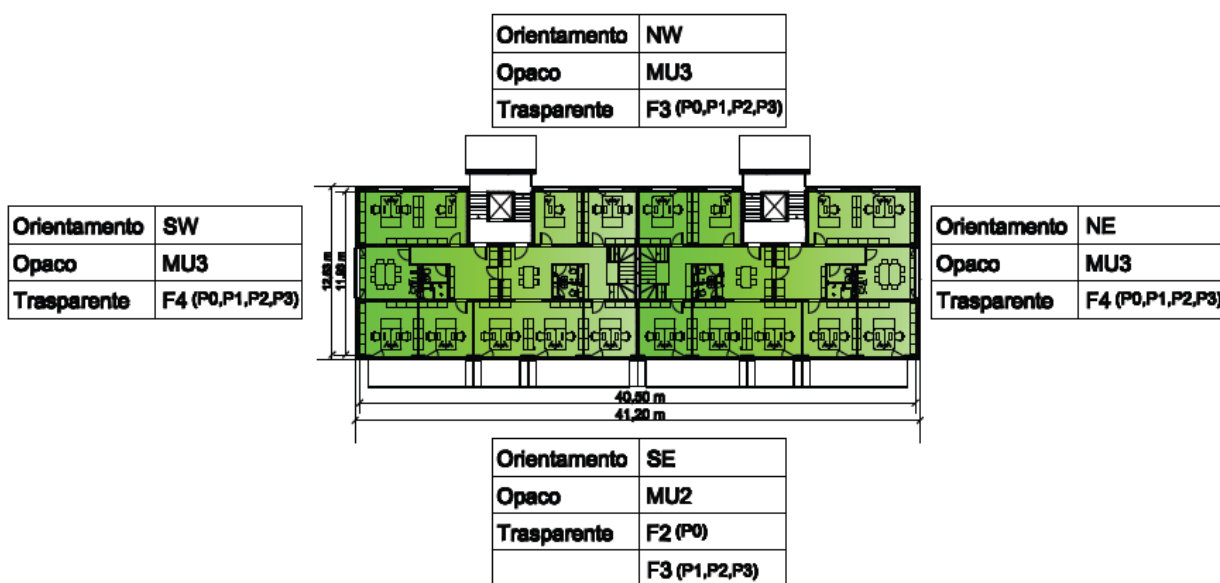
Pianta del piano tipo indicante le tipologie di chiusura opaca e trasparente a seconda delle esposizioni
